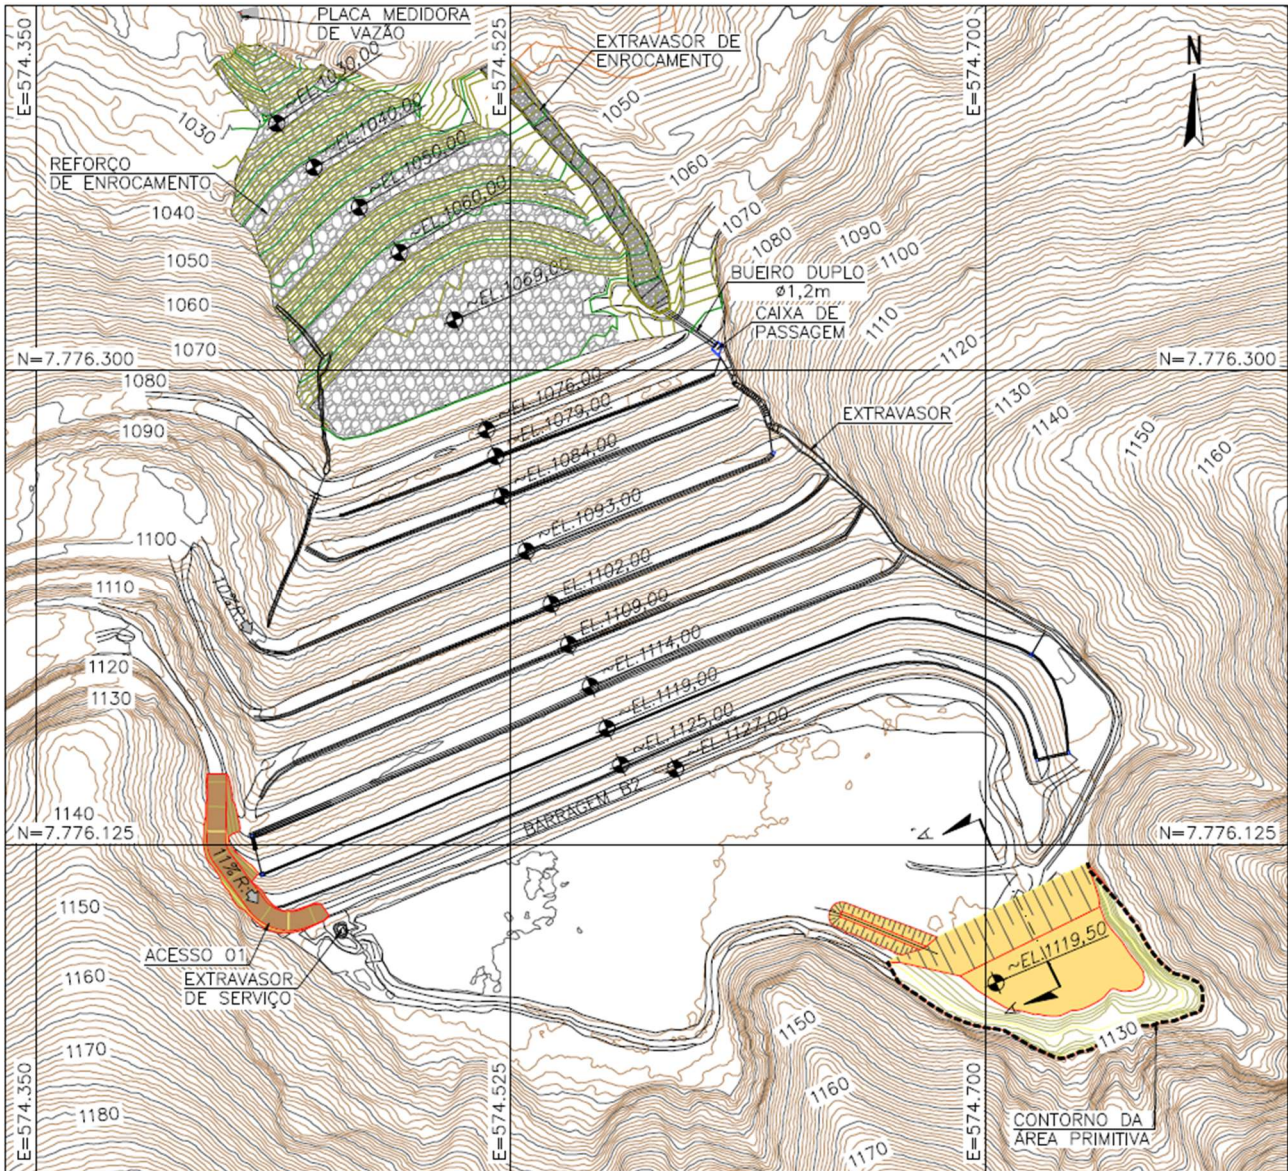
Sequência Construtiva - Planta - Fase 1A.
